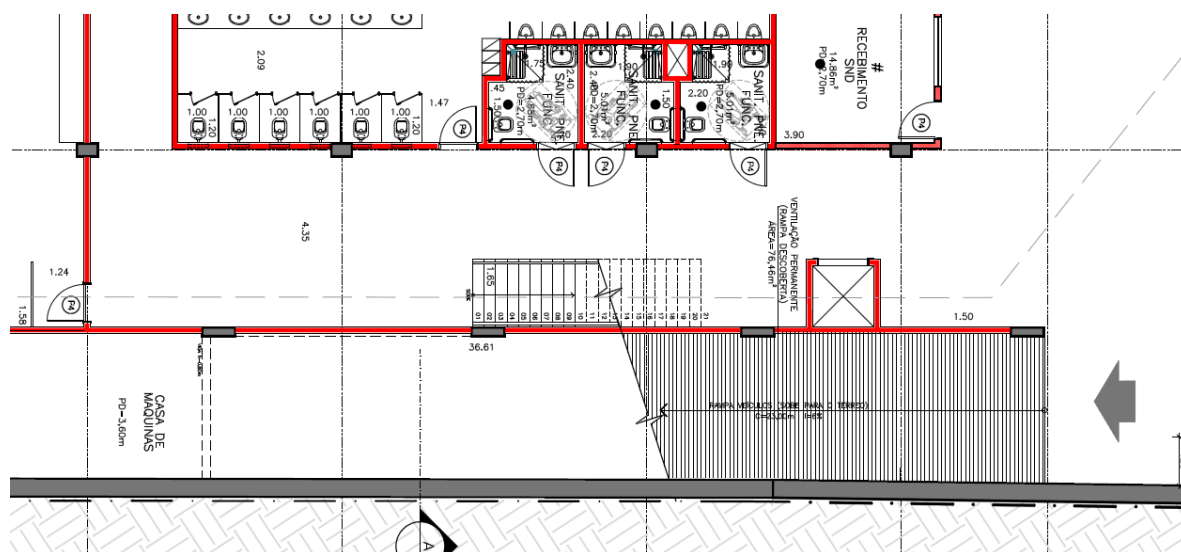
Planta do 1º Subsolo - Detalhe da rampa de acesso descoberta.
